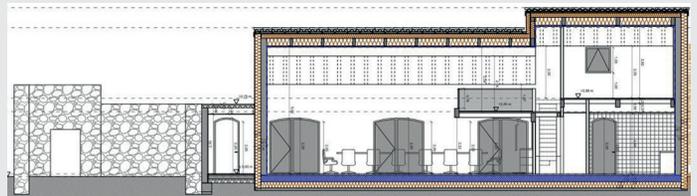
Detalle constructivo de proyecto. Toda la envoltente con detalle de Termoarcilla y cubierta y líneas continuas de hermeticidad y aislamiento.
